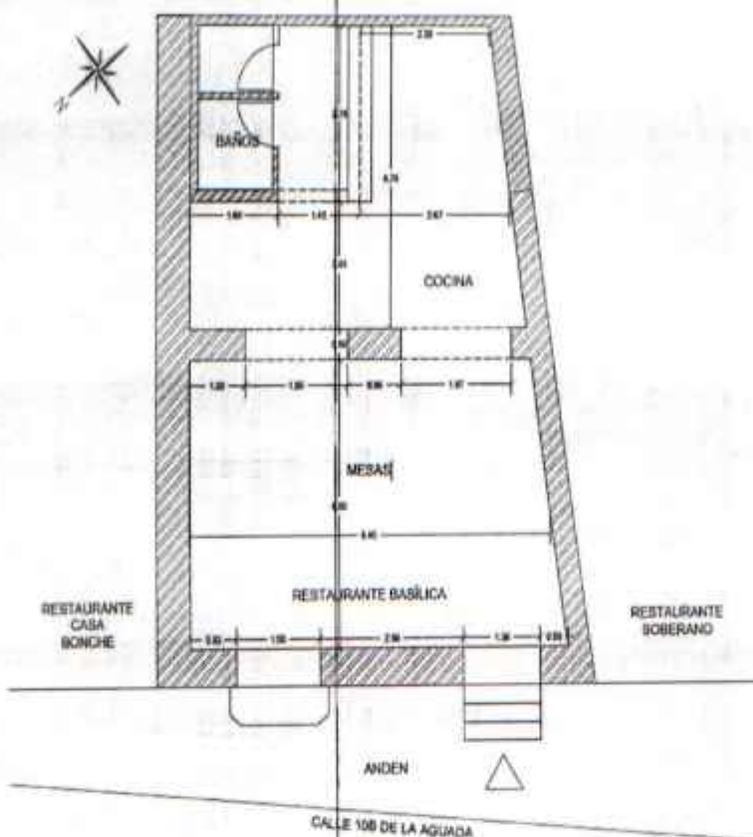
Plano RESTAURANTE BASÍLICA PIZZERÍA CAFÉ-Área privada
